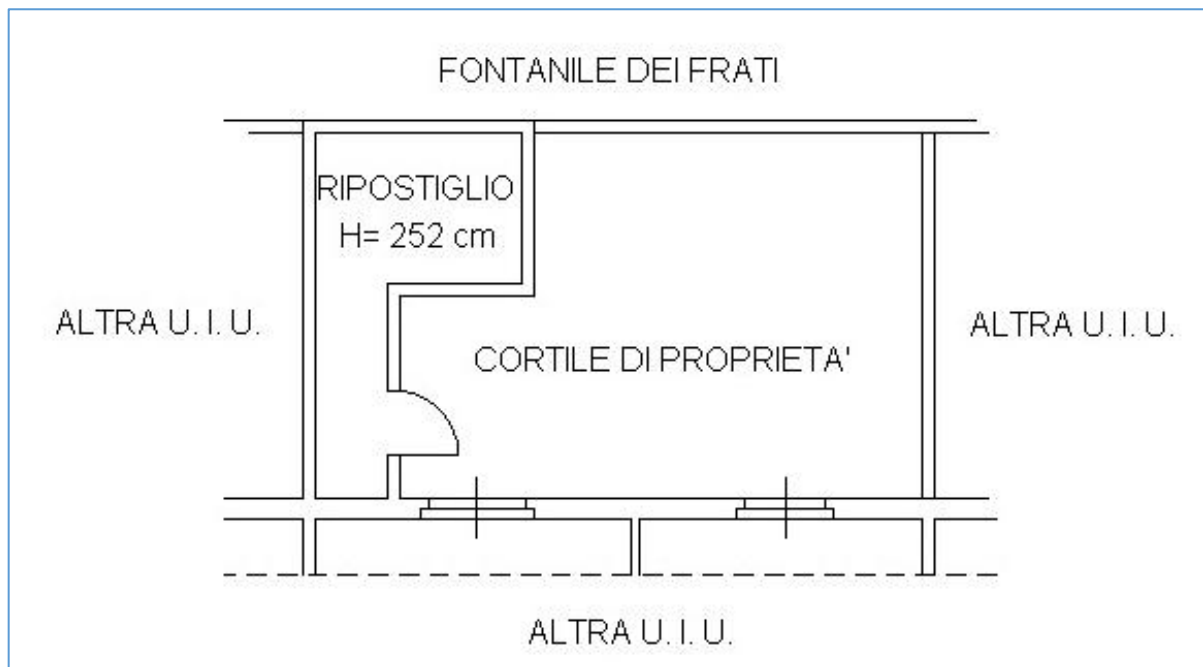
Estratto planimetria catastale del ripostiglio con terreno di proprietà
